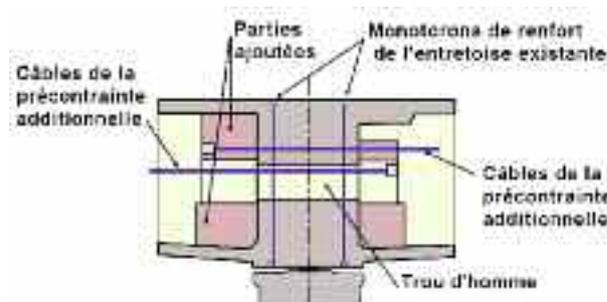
détail du renfort de l'entretoise sur pile pour l'ancrage de la précontrainte additionnelle
